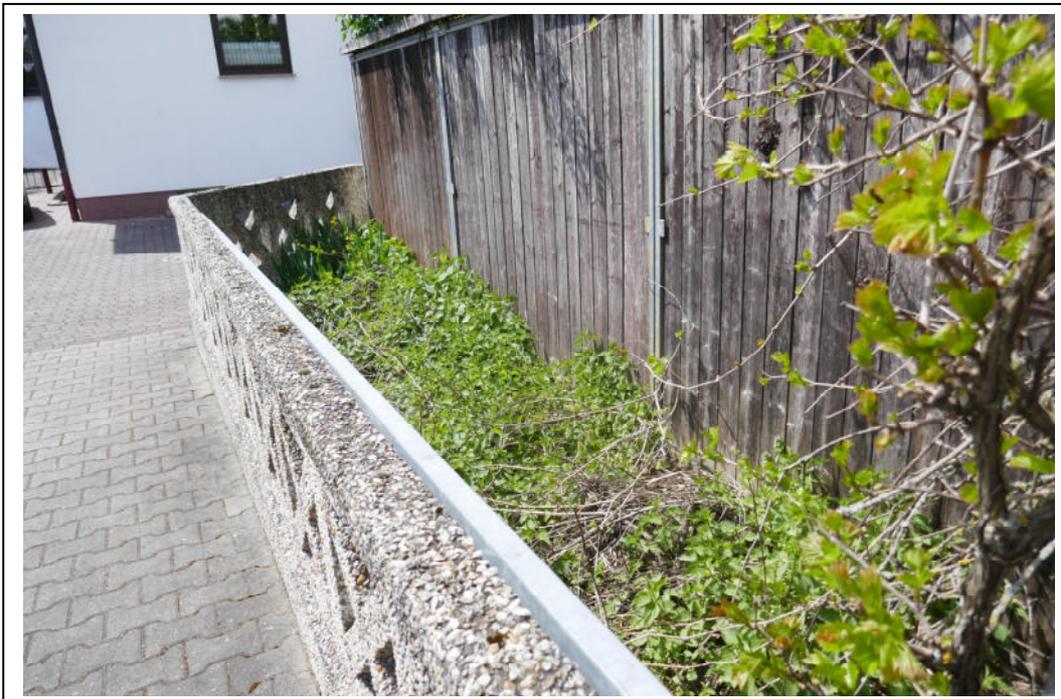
Zufahrtsituation über den seitlichen Wohnweg
